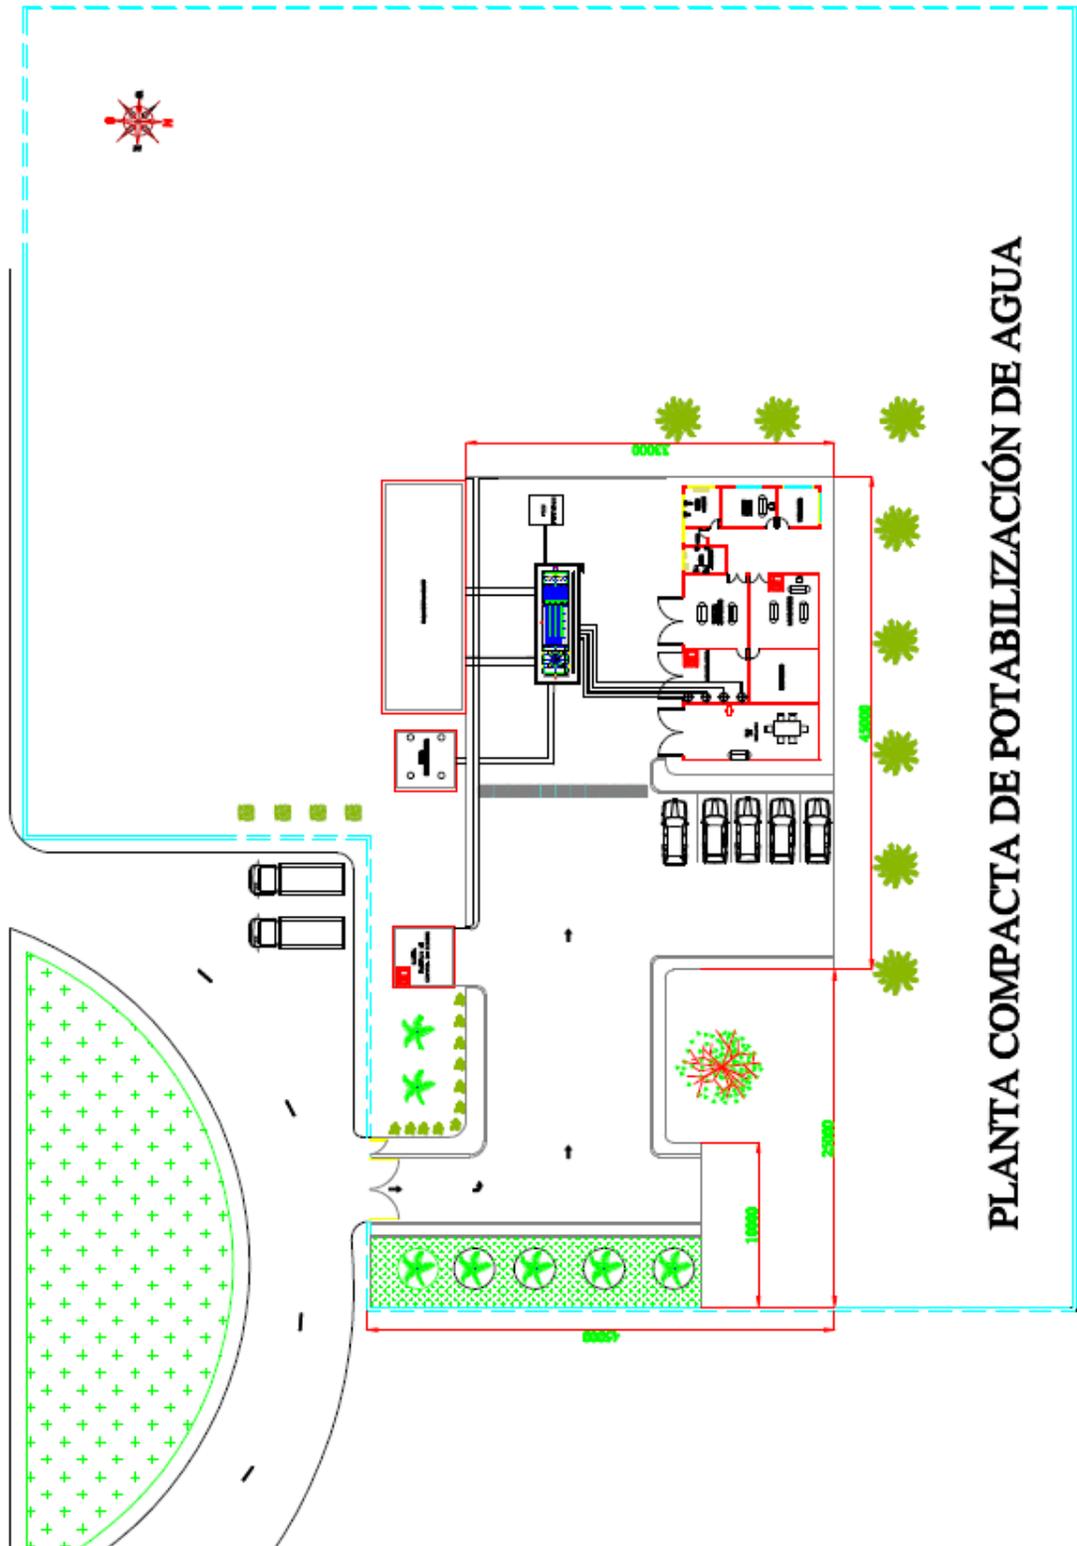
Plano de Distribución de Planta de la Planta Compacta de Potabilización de Agua.
